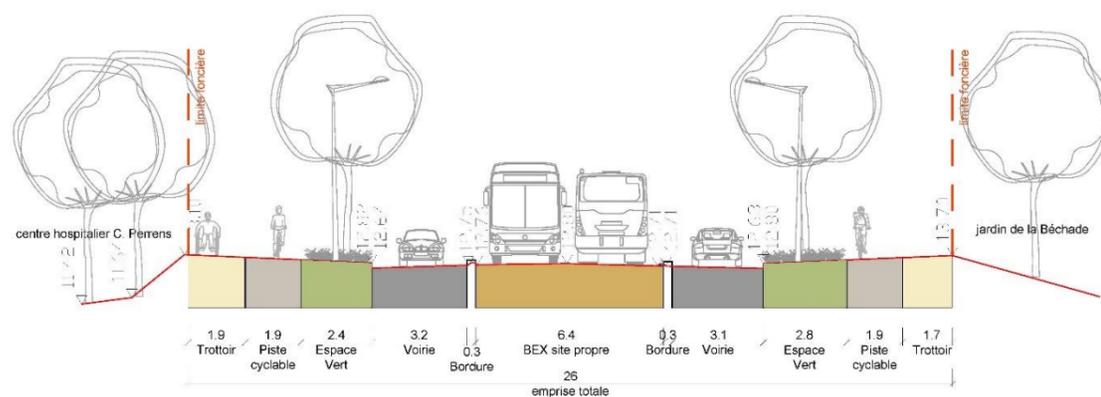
Coupe type sur la rue Antoine Bourdelle en section courante
